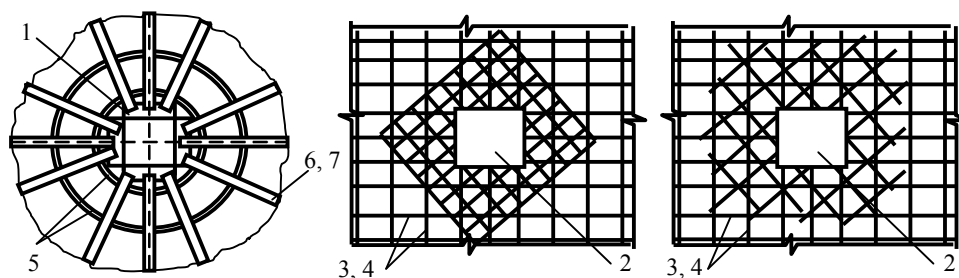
Схема армирования плиты перекрытия сборного безригельного каркаса здания 1 – коробчатый закладной элемент; 2 – отверстие для колонны; 3, 4 – арматурная сетка плиты; 5 – кольцевые арматурные элементы; 6, 7 – радиальные арматурные элементы
